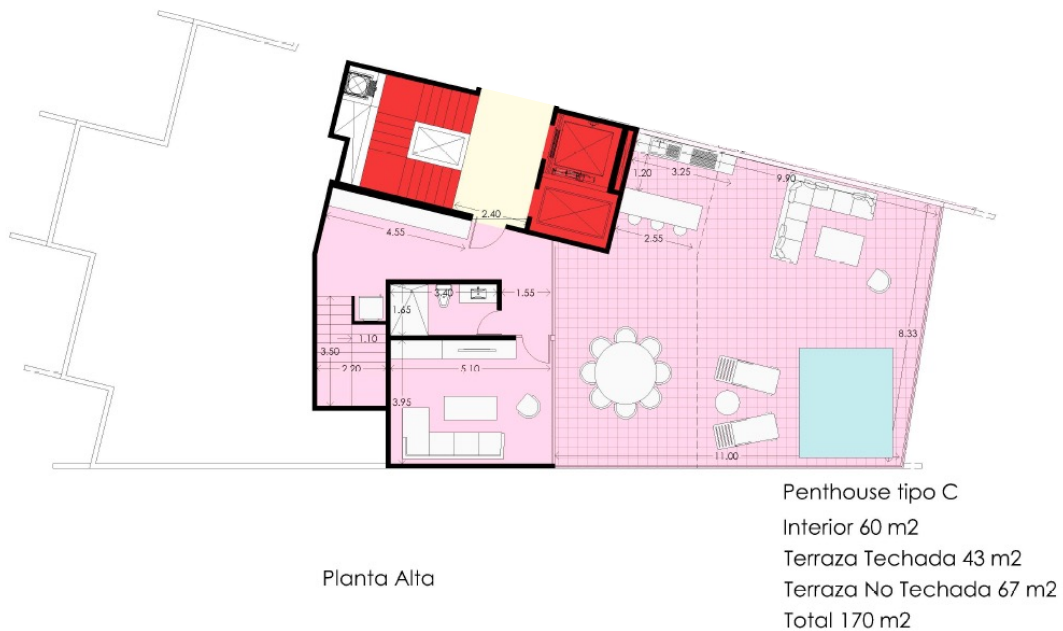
PLANTA ALTA PENTHOUSE TIPO C
